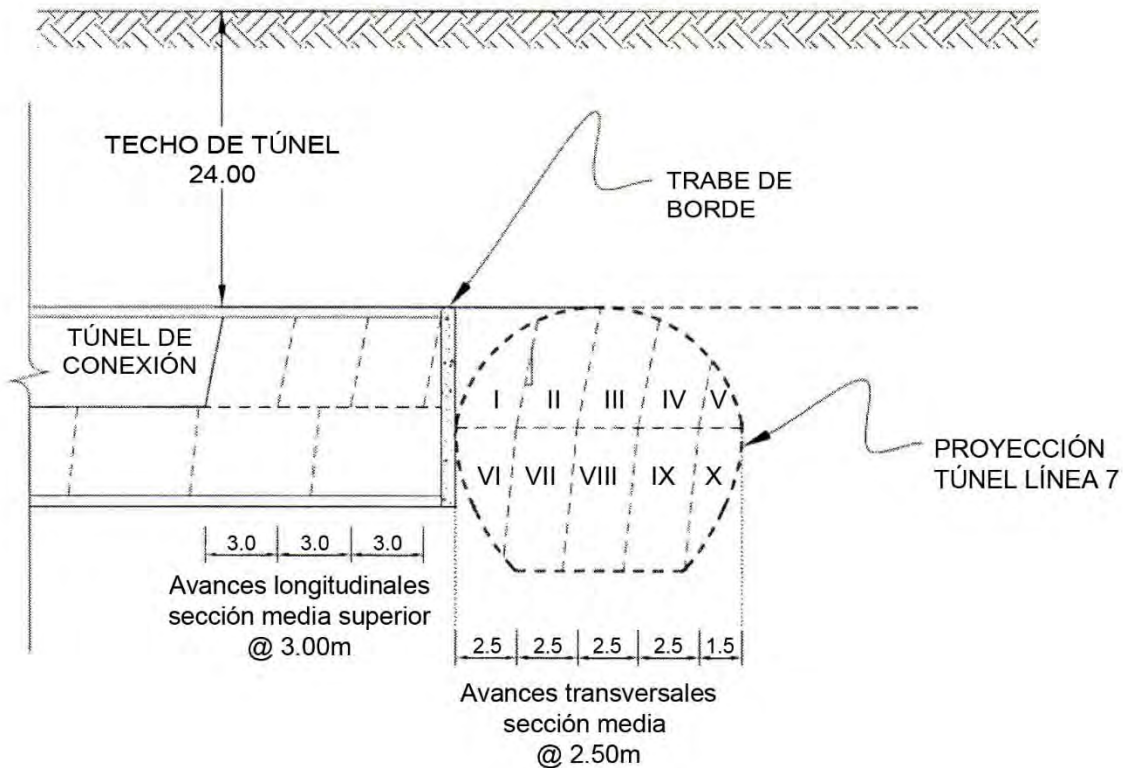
Procedimiento constructivo para el Túnel de Conexión y la unión con Túnel de L-7.
